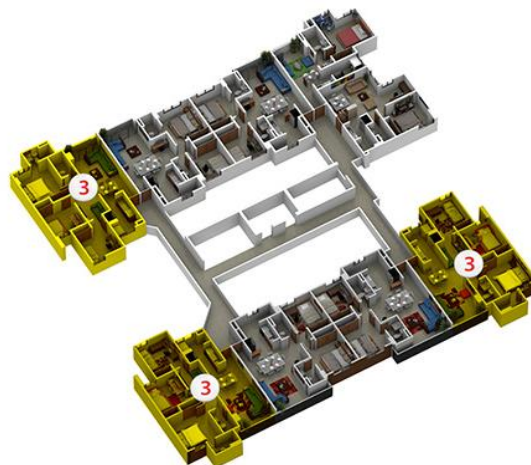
Planta tipo del proyecto Quantum. Hay apartamentos de tres y dos alcobas, y aparta estudios
